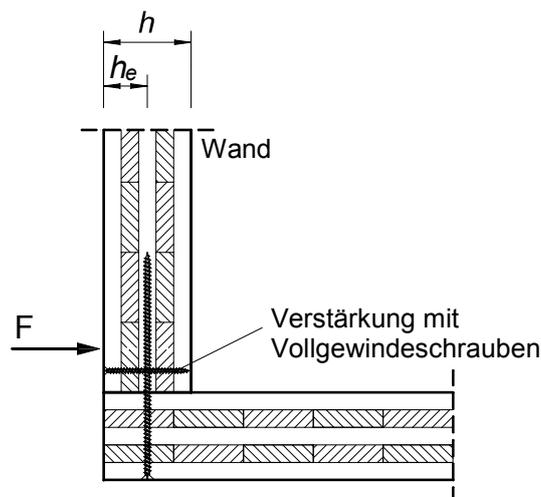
Verstärkung einer Brettsperrholzwand mit Vollgewindeschrauben
